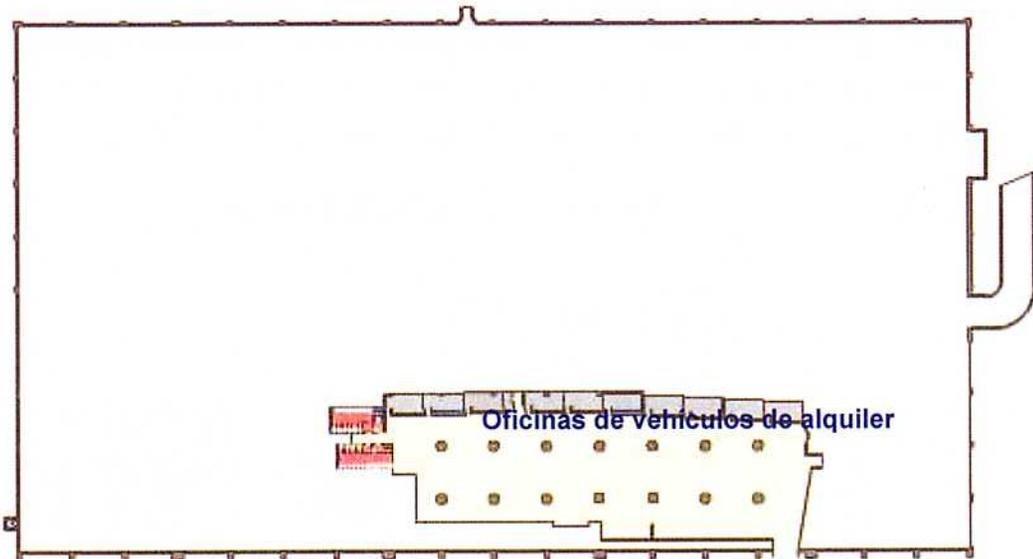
Planta baja (Nivel 00) Terminal T2
